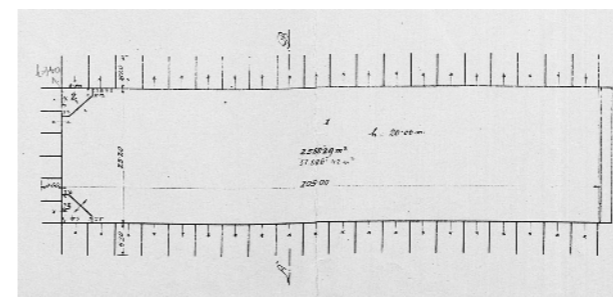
Stagl-Mannsbarth-Halle Grundriss
